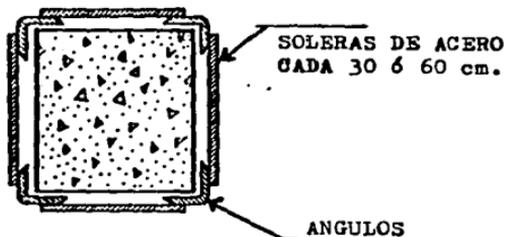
Apuntalamiento con ángulos y soleras de acero.
